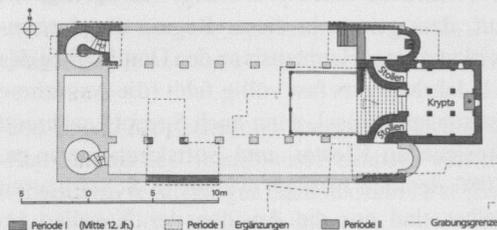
Wiesenbach, Propsteikirche. Grundrissrekonstruktion (nach K. Laier-Beifuss).
